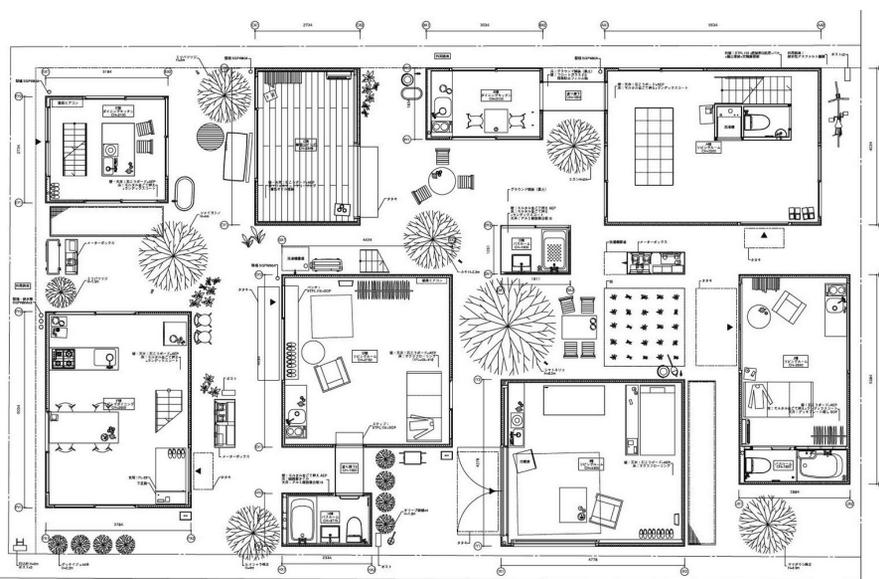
Das Moriyama Haus, Grundriss
